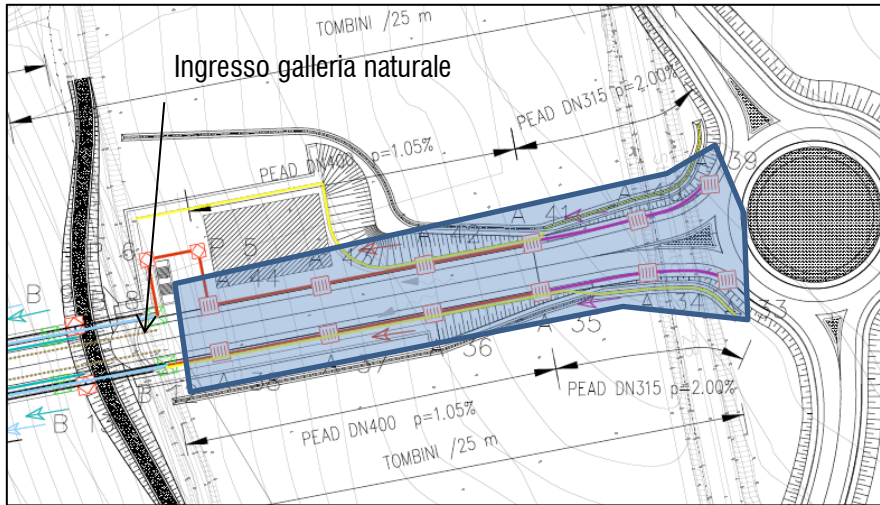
Area di progetto interessata alla laminazione dovuta alla vasca V1.
